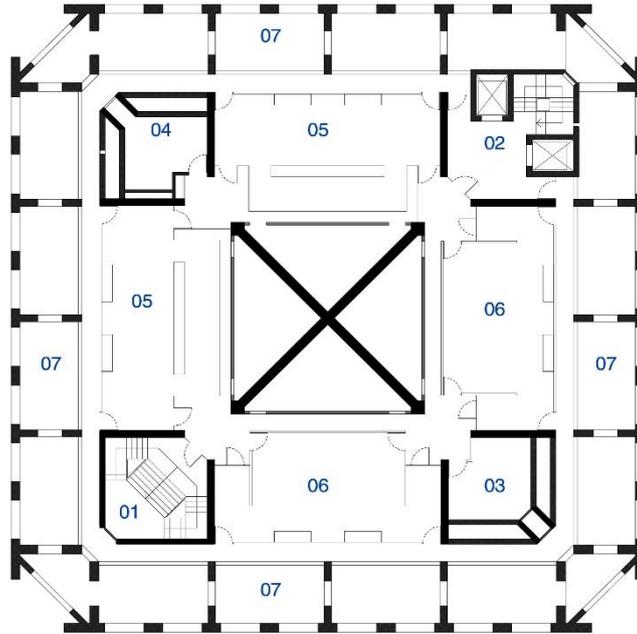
| Planta do oitavo pavimento [redesenho do autor]
